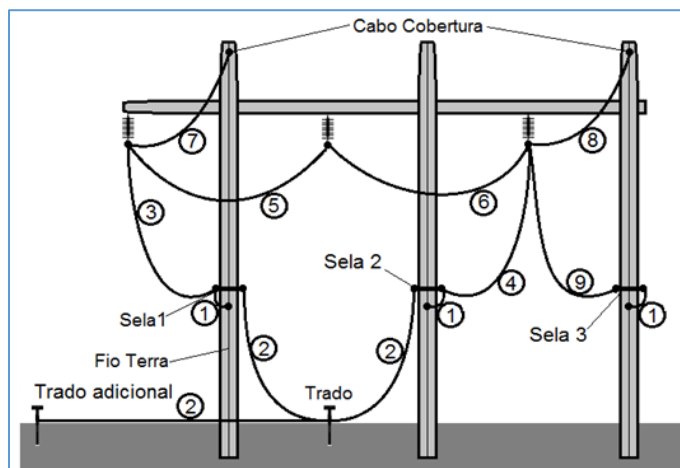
Conjunto para estrutura de madeira e concreto circular ou duplo T
